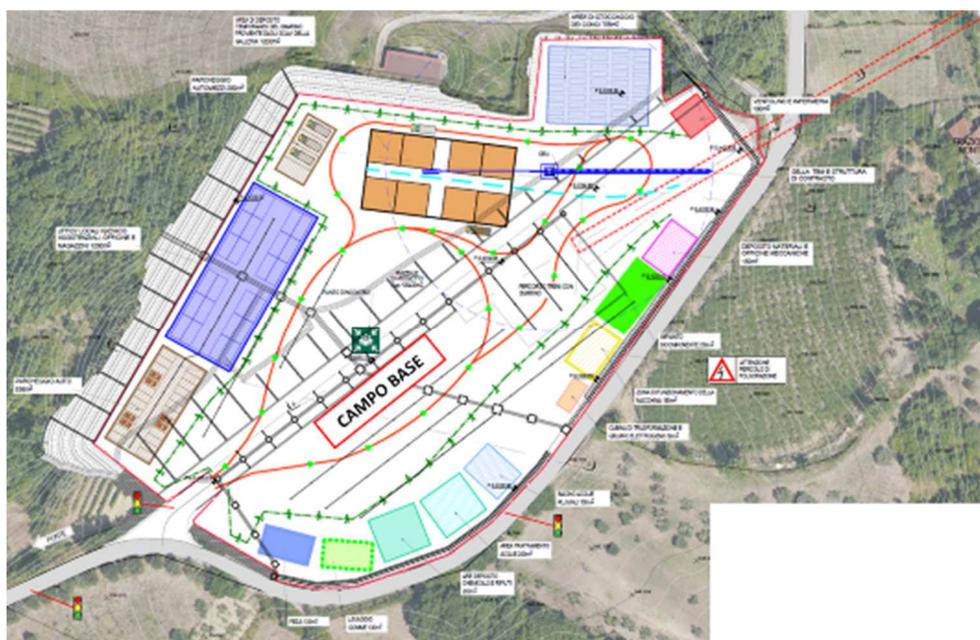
Layout campo base CB e cantiere scavo galleria di derivazione (COS1)
